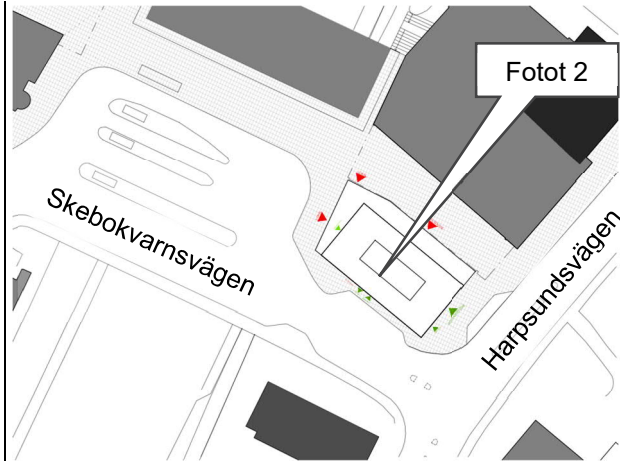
Övre garageplan i kvarter Önskehemsplan. Illustration 2024-03-18.
